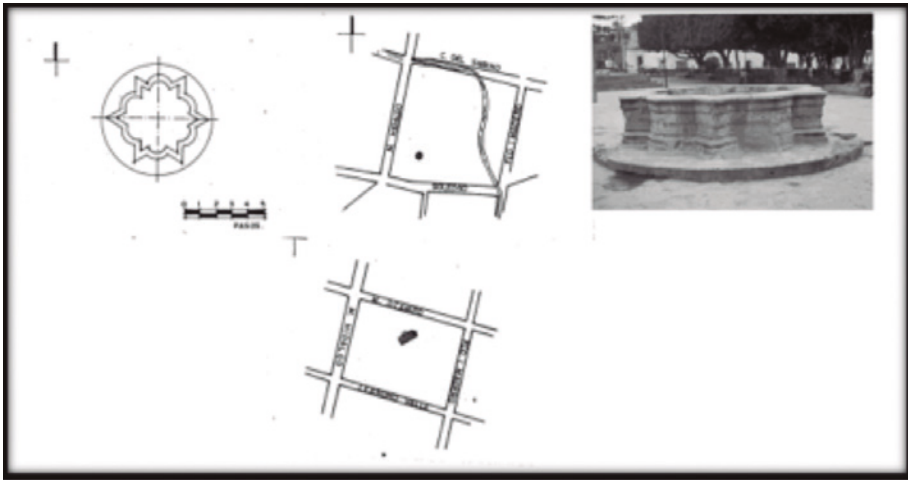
Planta y fotografía de la fuente de La Soledad, barrio purhépecha de Acámbaro (Catálogo INAH).
